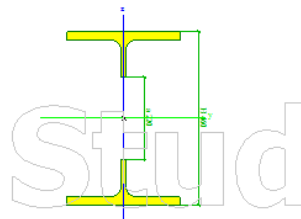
Detail prolamovaného průvlatku z HEB 360
